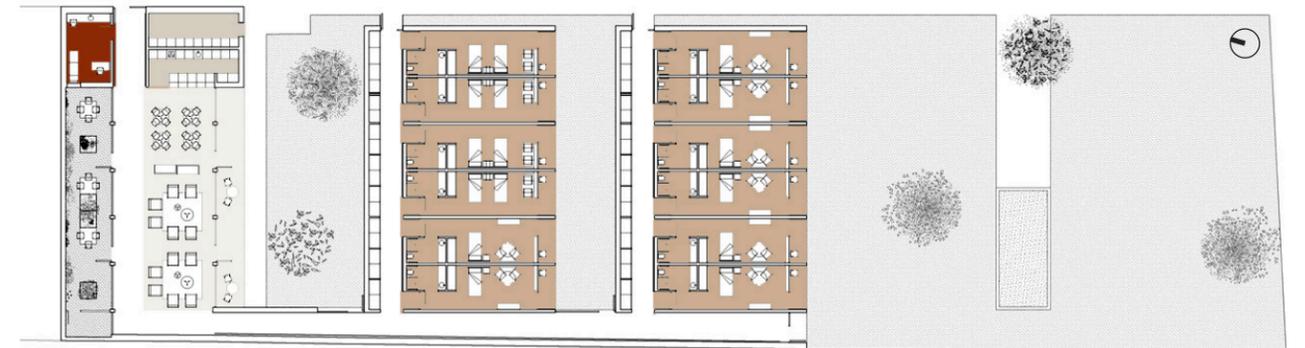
Adaptada de CSO arquitectura. (2020). Planta baja, zonificación. [imagen].
